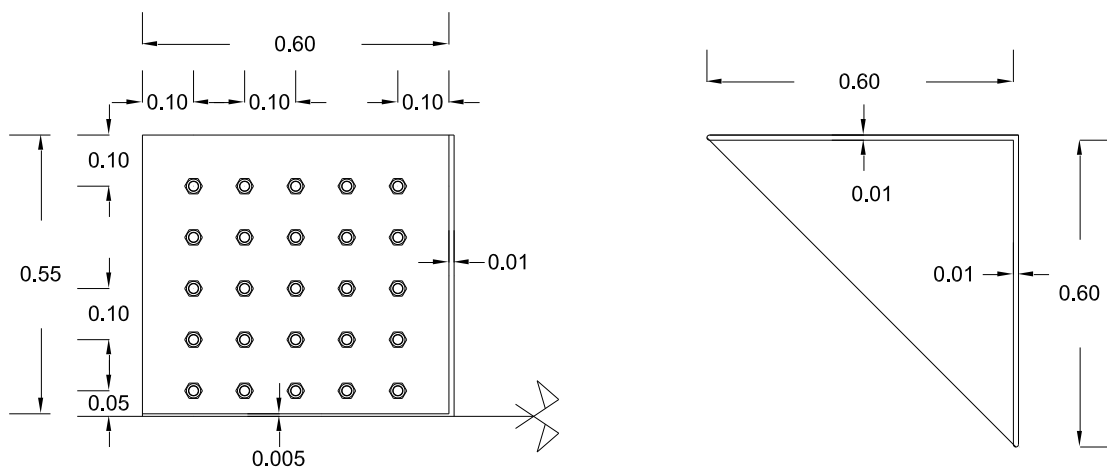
Geometria da chapa de ligação entre as vigas principais (unidades em [m])
